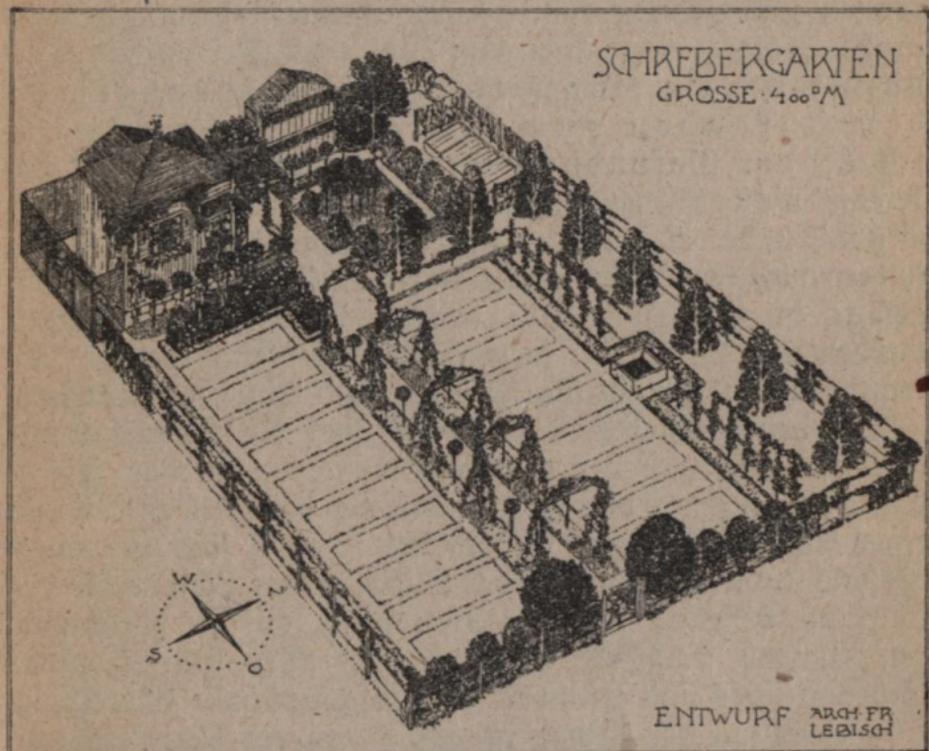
Schaubild zu dem Plan in Fig. 4.
